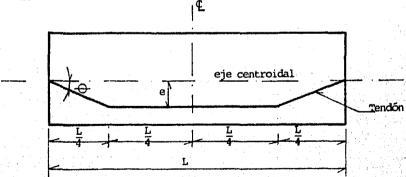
Viga presforzada con un tendón de cierta pendiente en sus extremos.
